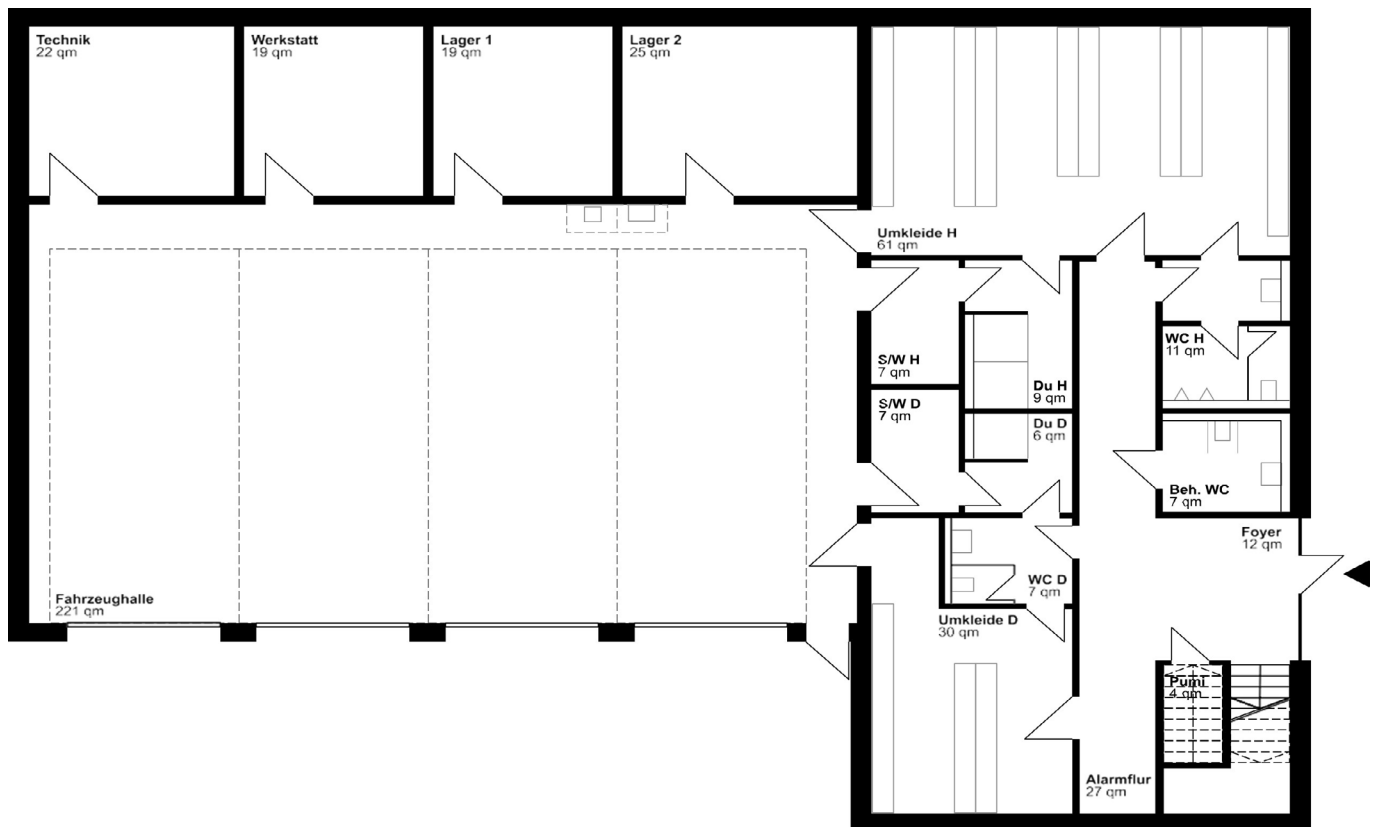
Musterraumprogramm 4 Stellplätze zweigeschossig (UG), Grundrissplan
